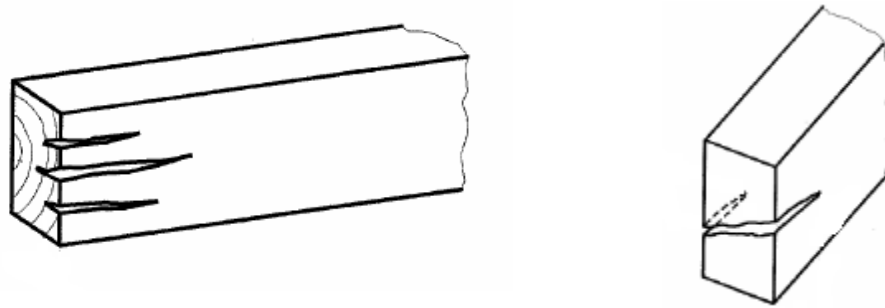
(Izquierda) Fisura no pasante o grieta. (Derecha) Fisura pasante o rajadura (1).
